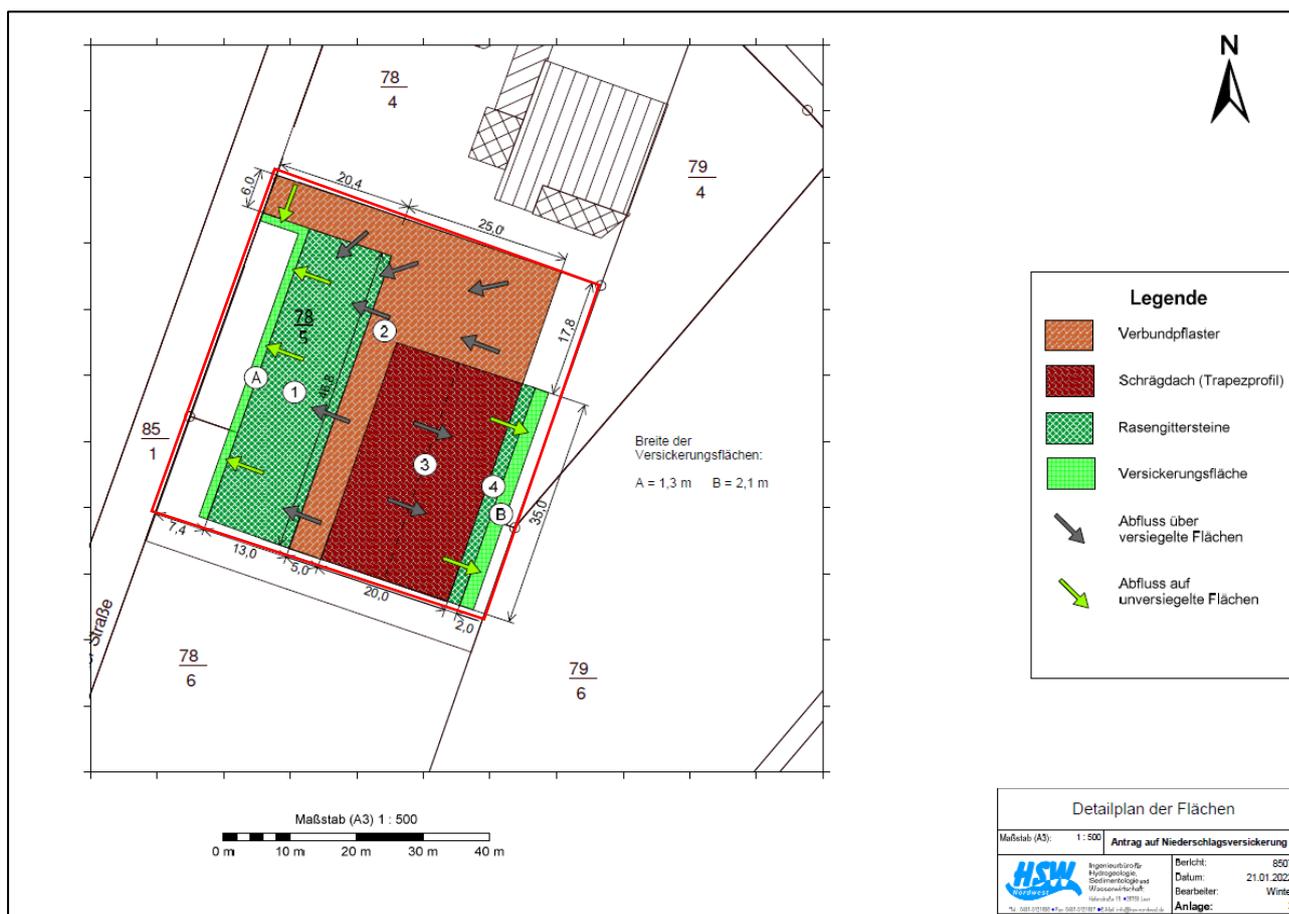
Entwässerungsplan mit eingriffsbilanzierem Bereich (rot umrandet)
